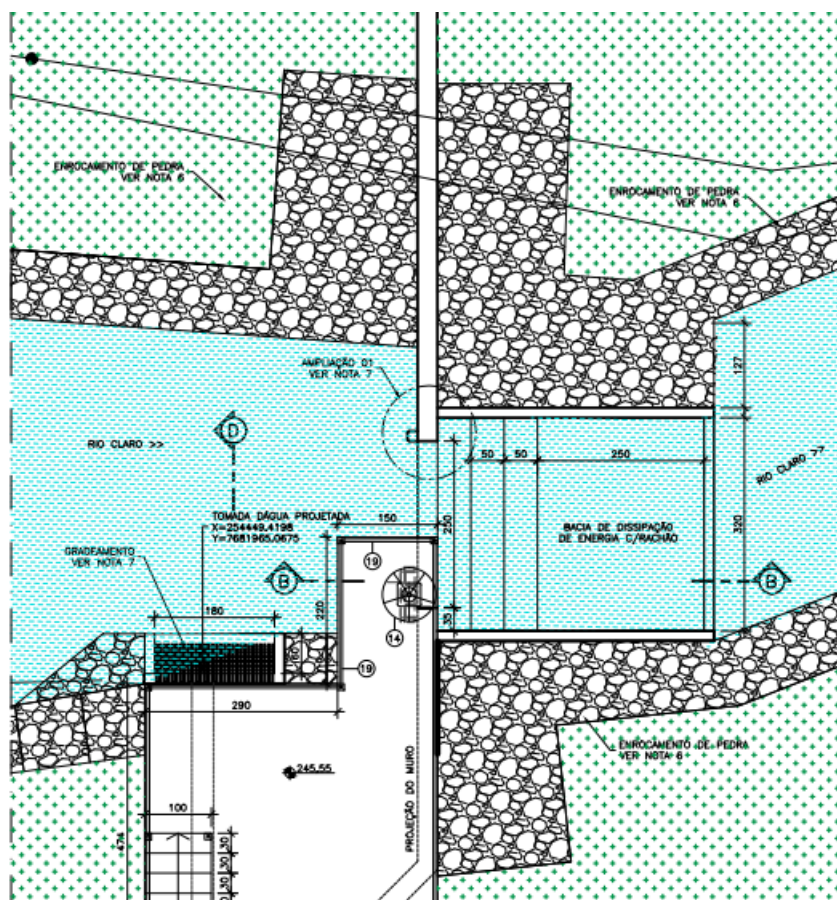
Indicação em planta da seção transversal B-B, considerada nas análises.
